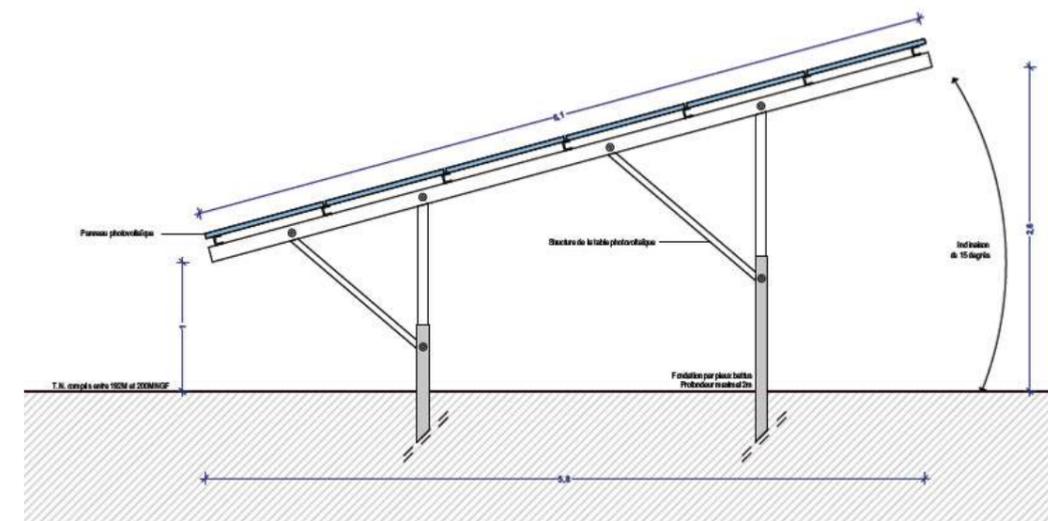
Exemple d'une coupe schématique d'une structure photovoltaïque – Fondation par pieux (Source : EDF Renouvelables)
